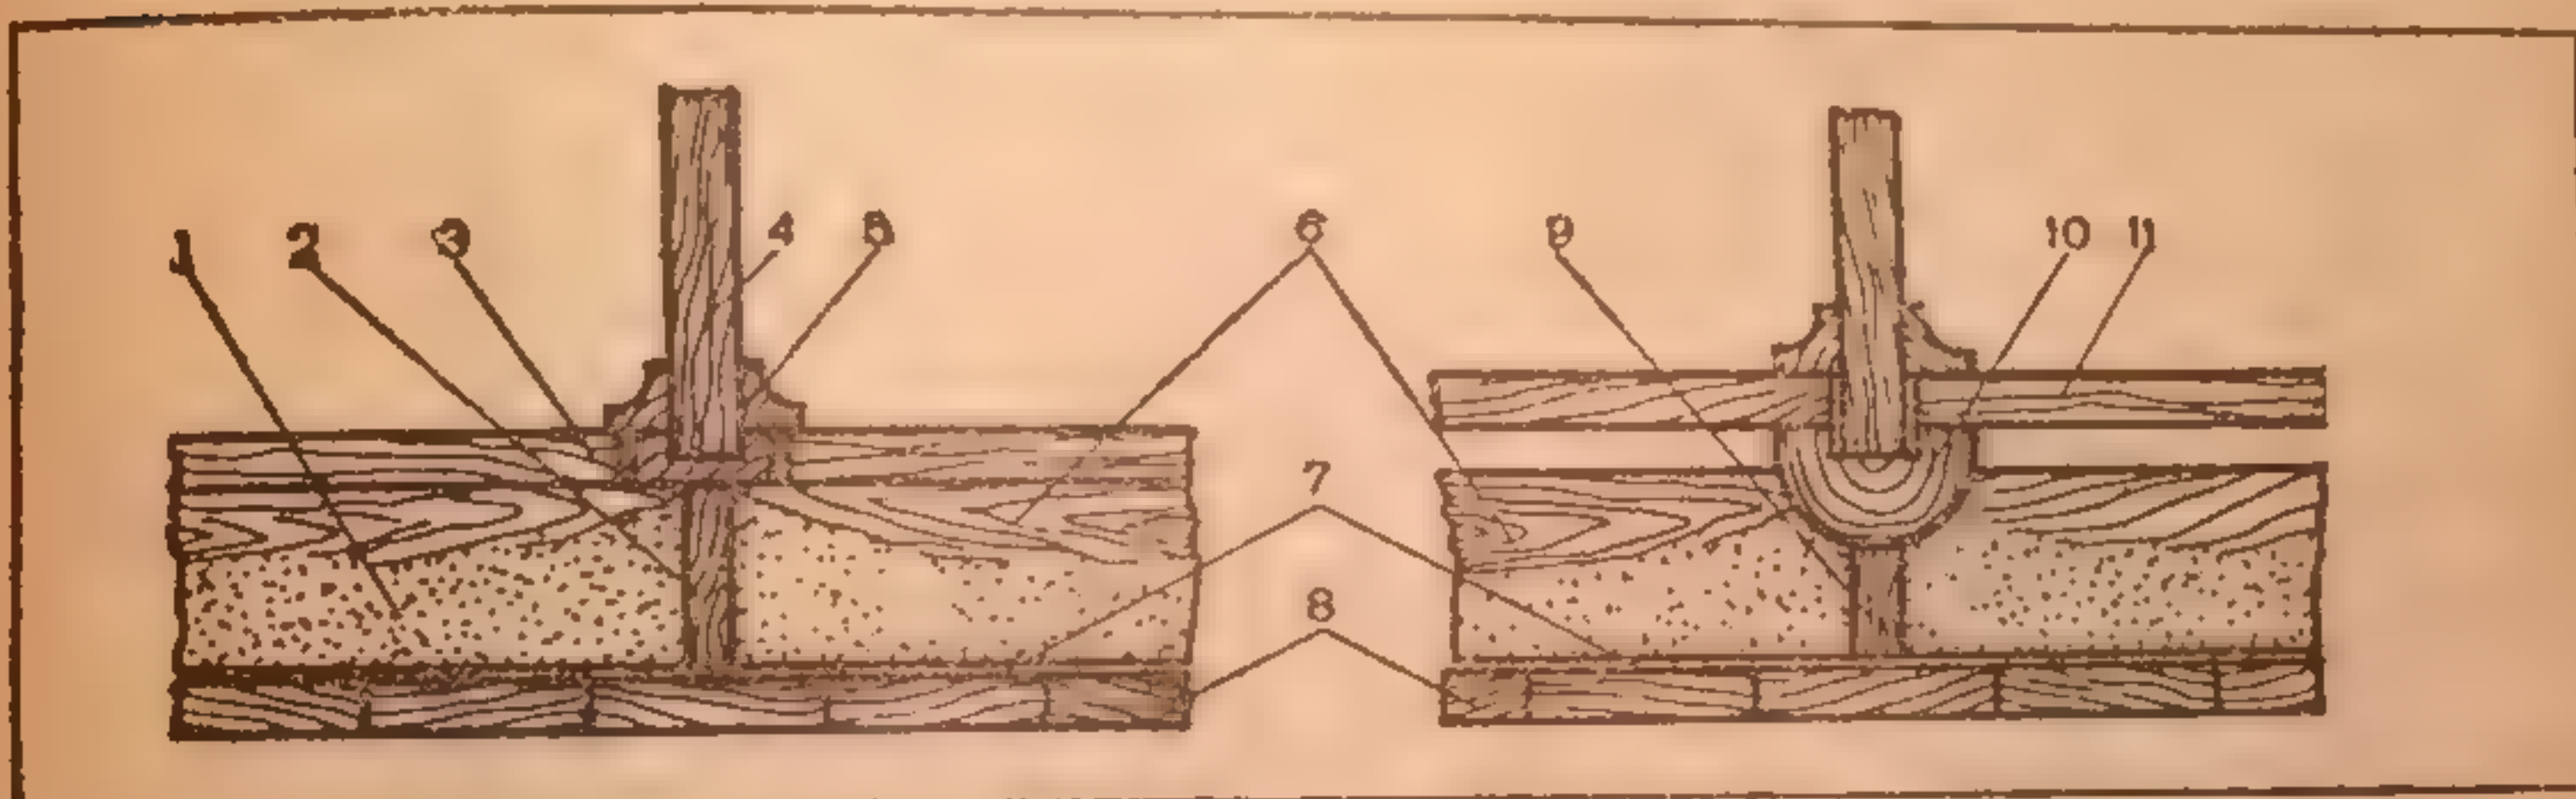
Перегородка располагается поперек балок и опирается прямо на балки или лаги:
